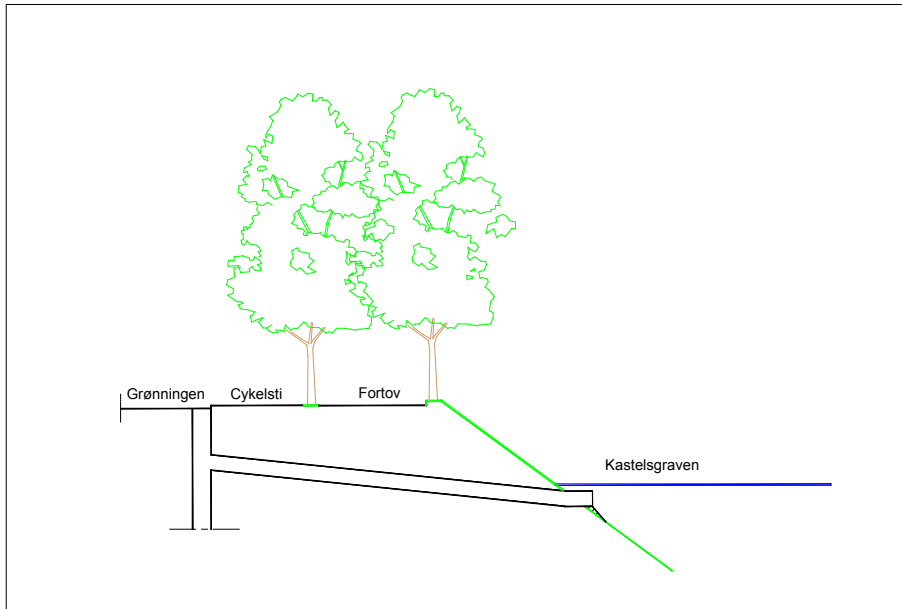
Opsamling af regnvand via rist til lukket rørløsning med overløb til Kastelsgraven (blå pile)
